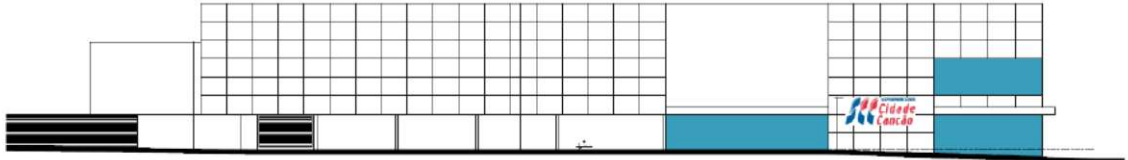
Elevação – Av. das Laranjeiras. Fonte: Projeto Arquitetônico.
